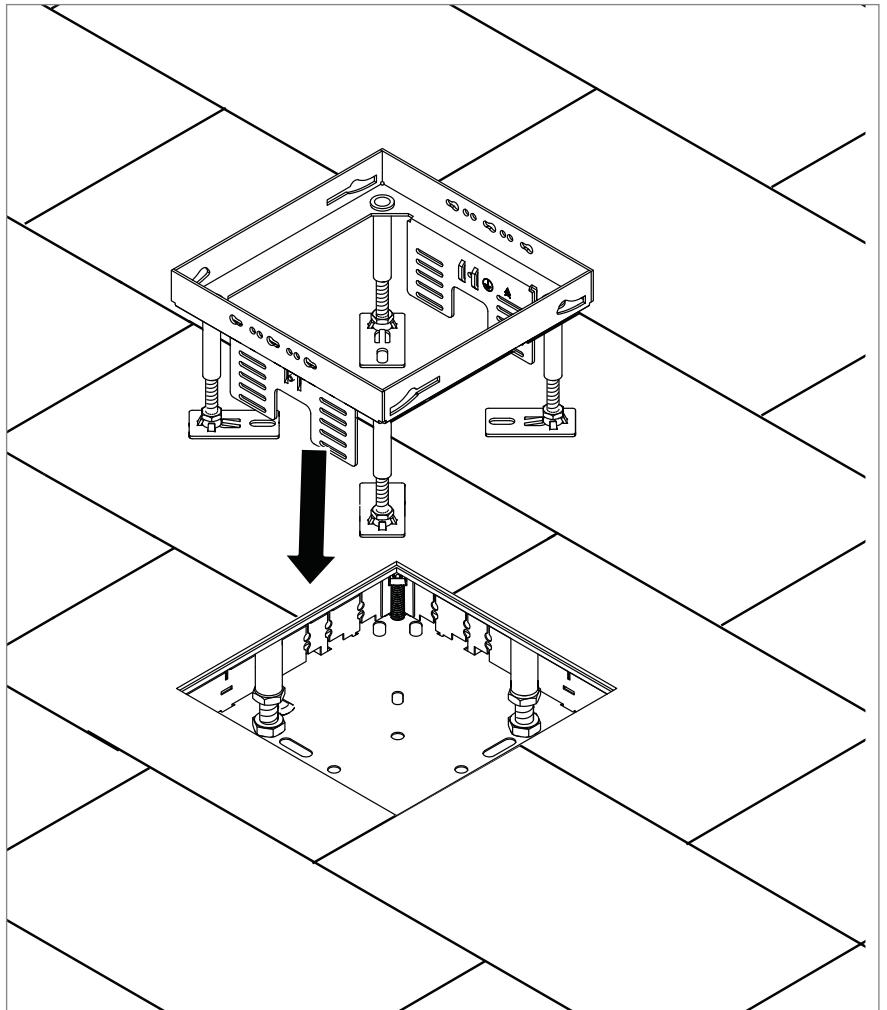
Montaje del conjunto de tapa y marco para cargas pesadas
